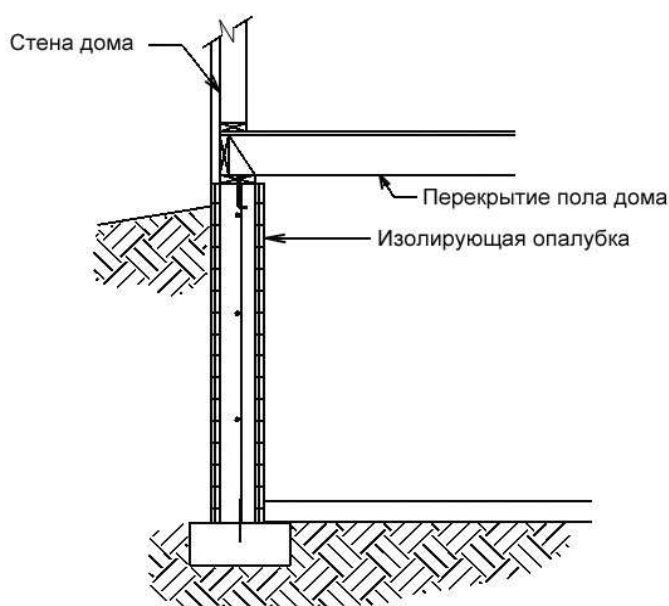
Схема фундамента, построенного с помощью изолирующей опалубки
